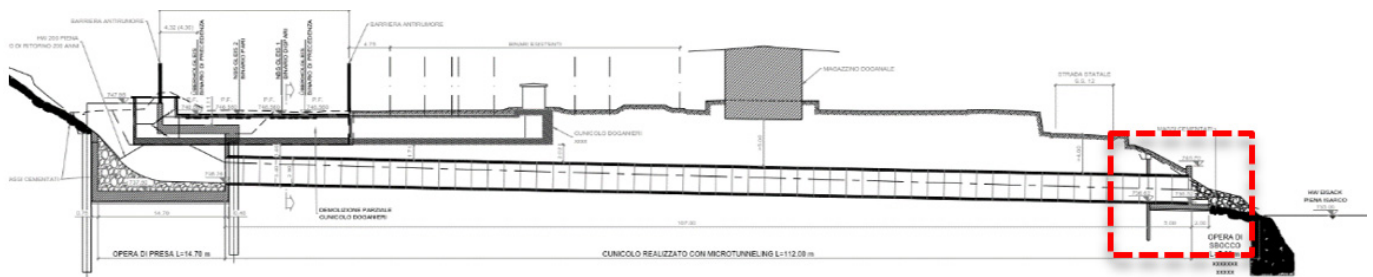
Längsschnitt und Einordnung Auslaufbauwerk
